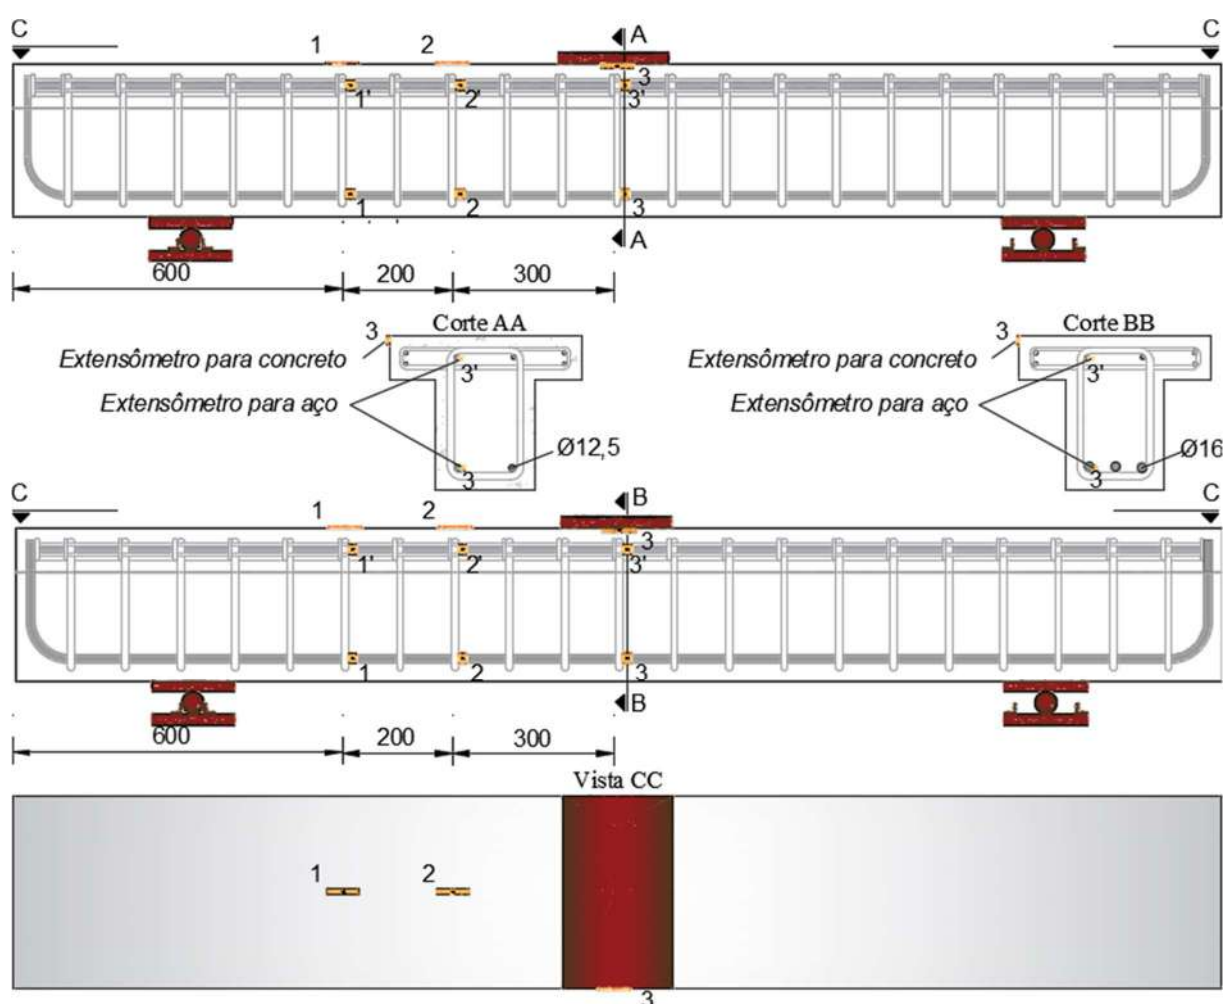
Posicionamento dos extensômetros nas vigas (mm).
